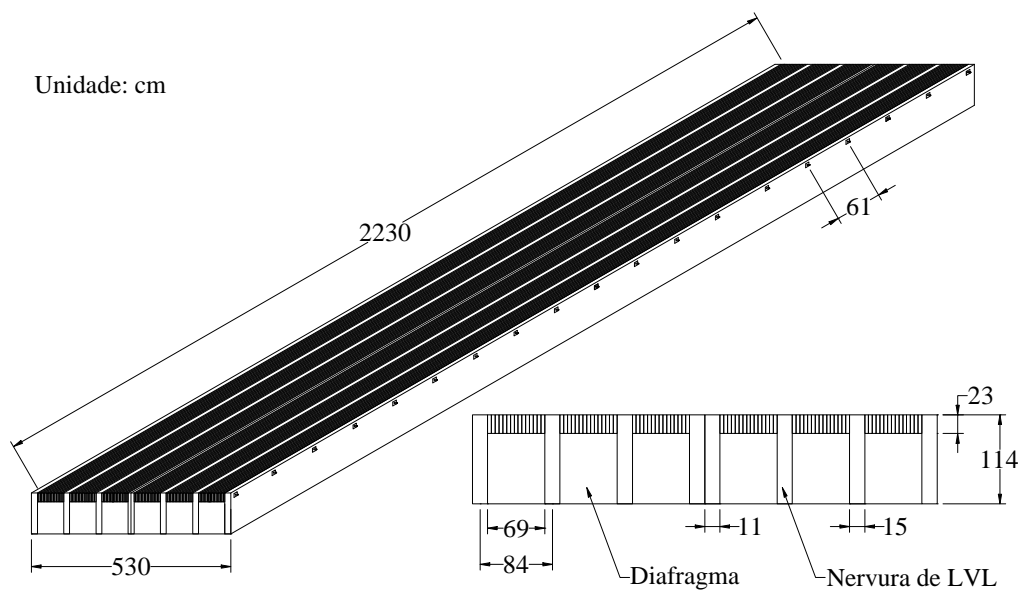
Dimensões da Ponte “Barlow Drive”
